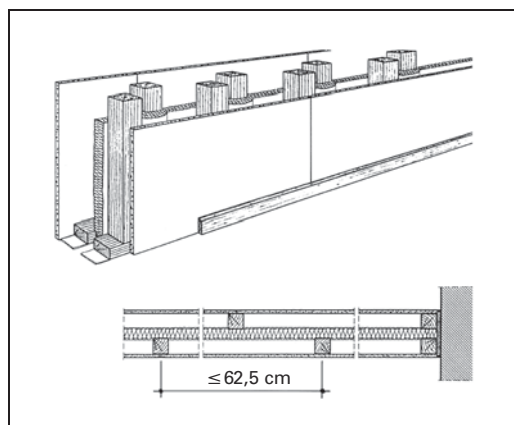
Holzdoppelständerwand, einfach beplankt
